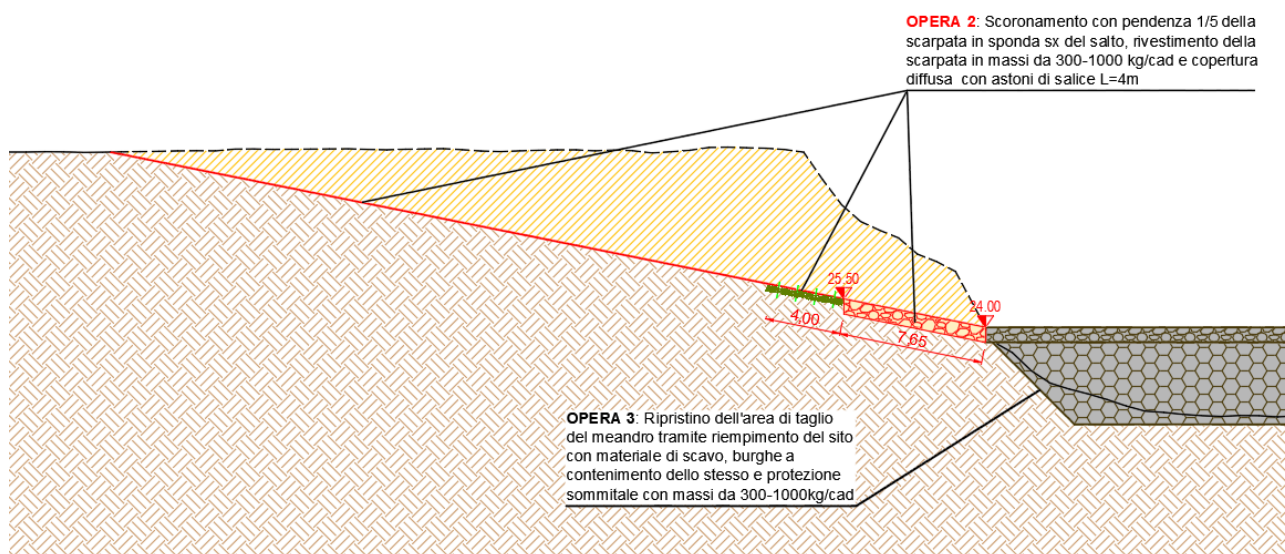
Opera 2 - Estratto Tav. PFTE.13 - Sezione Tipologica
